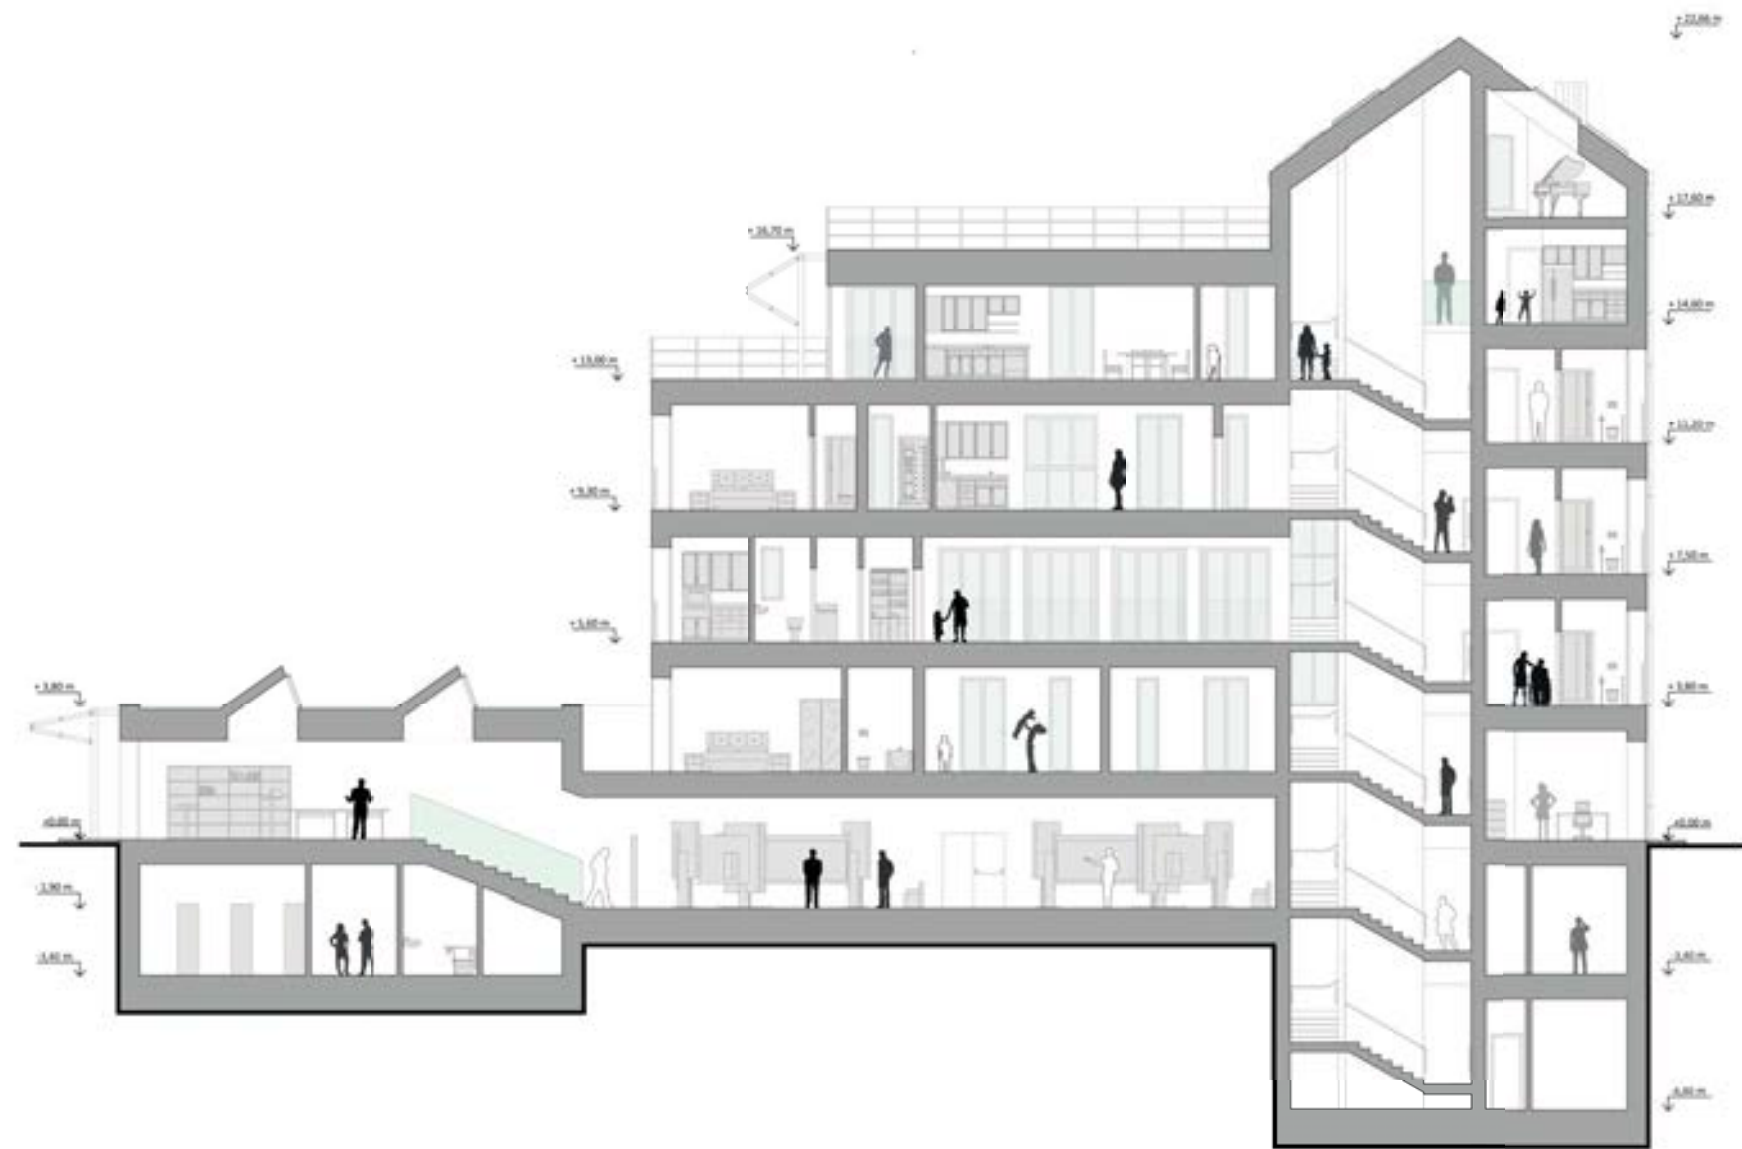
Sezione architettonica longitudinale in direzione nord-sud
